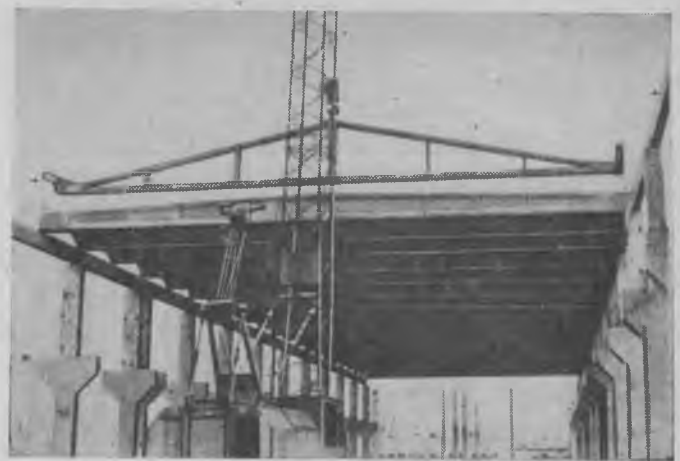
Укладка керамзитобетонных плит размером 3×18 м в покрытие базы УПТК Главкузбасстроя
